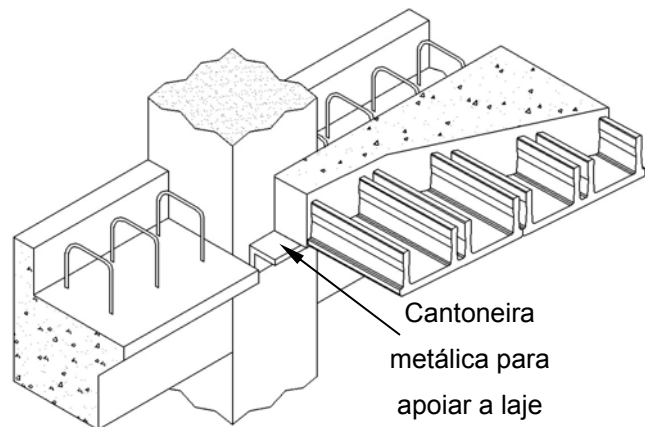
Apoio para equilibrar a laje durante a fase construtiva
